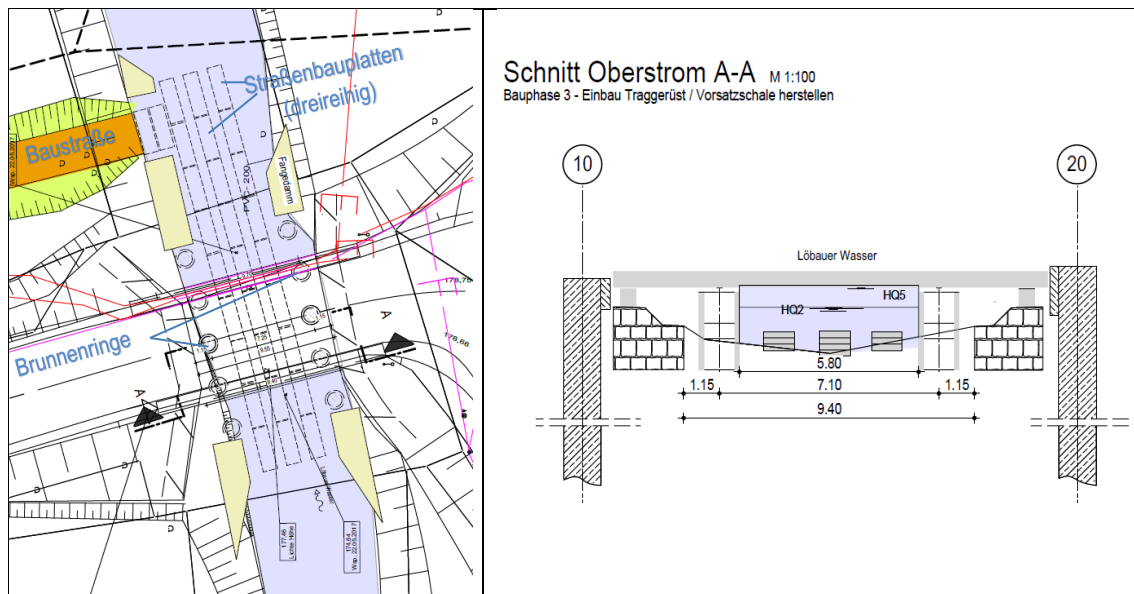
Lage der ursprünglich geplanten Baustraße im Löbauer Wasser sowie der mit dieser Lösung erforderlichen Brunnenringe. Rechts: Einbau Traggerüst zur Herstellung der Vorschale (INGENIEURBÜRO SCHULZE & RANK 2020: Bauphasenplan – Arbeitsstand vom 27.02.2020)
